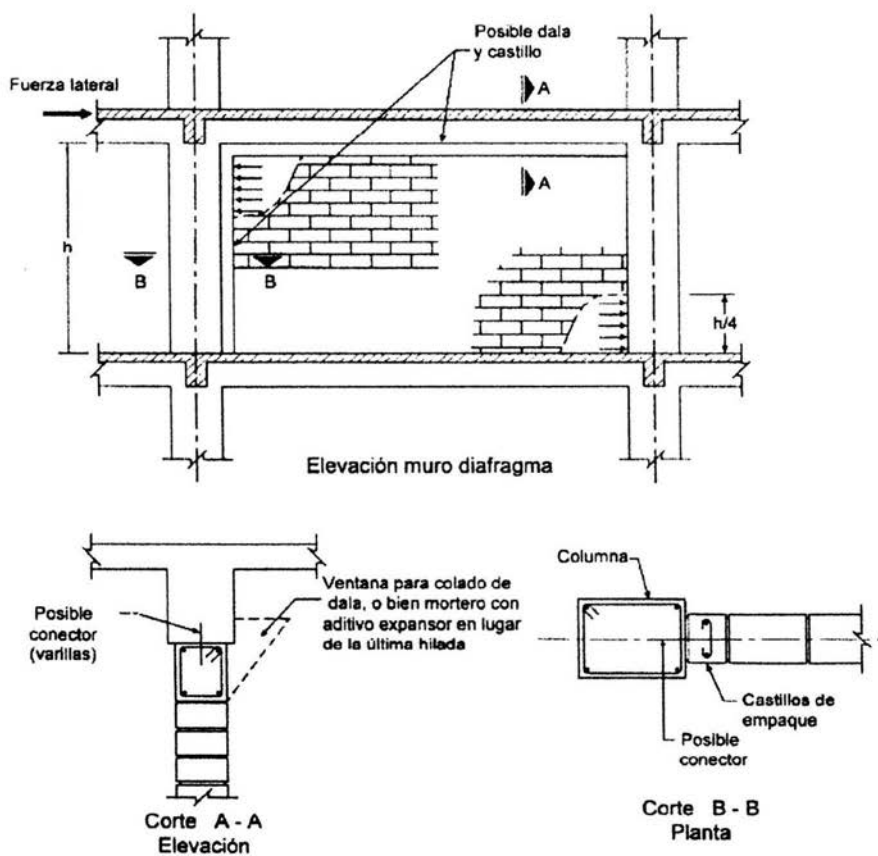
Elevación y detalles en planta de un muro diafragma.
